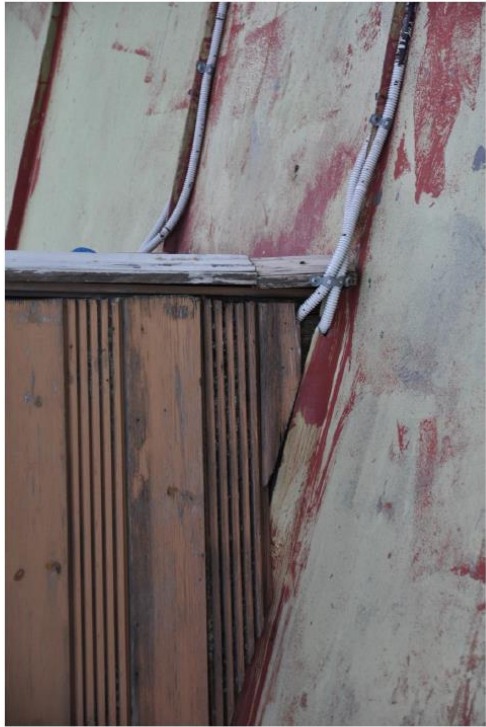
Конструкция системы подогрева карнизных свесов, водосточных труб. Отслоение красочного слоя окрытия кровли.
